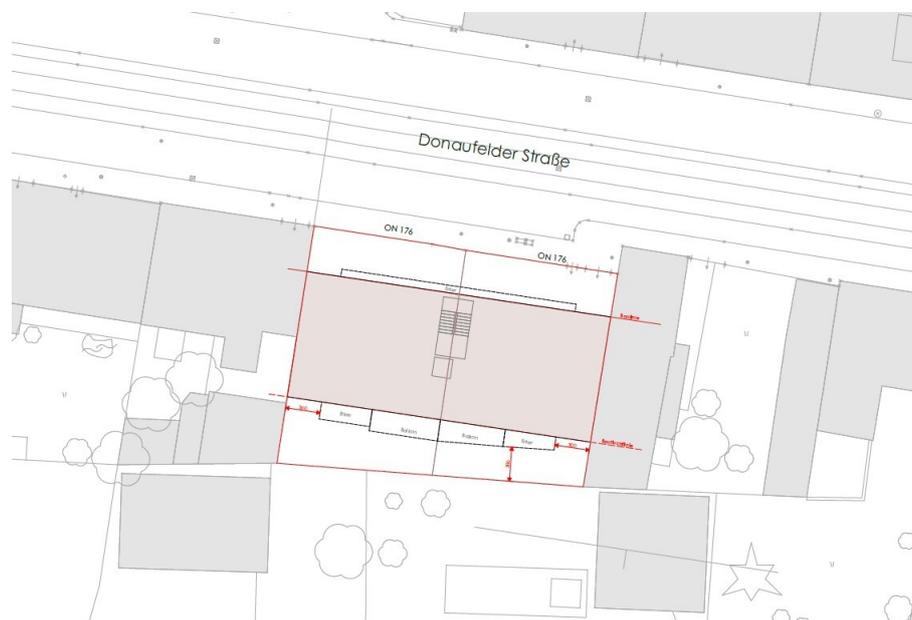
Lageplan 22. Donaufelder Straße 174-178
